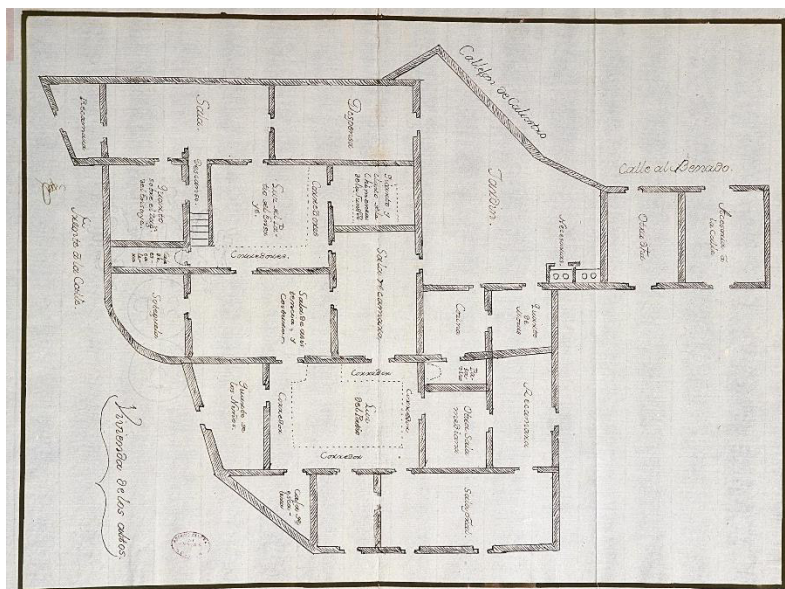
Planta Alta original. Casa del Real Ensaye 1786. Fuente: Archivo General de Indias S/N Escala
